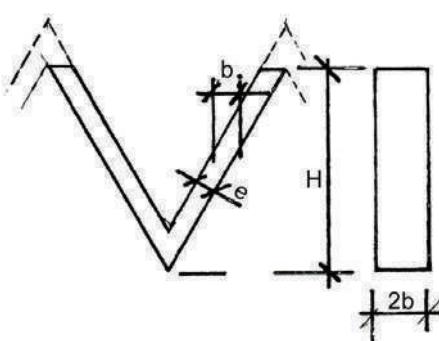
Viga retangular equivalente ($H \times 2b$) a viga em V. (*-5).
